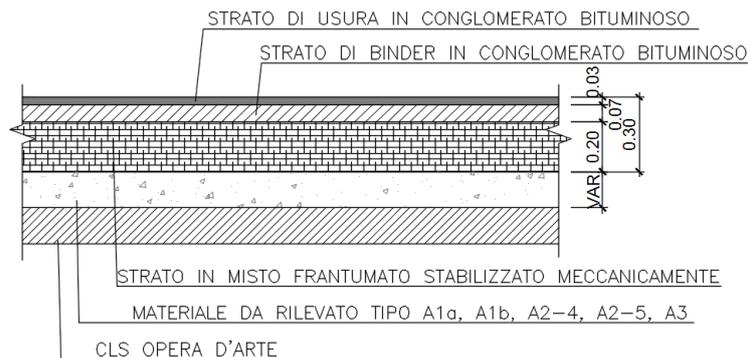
Sezione tipo in rilevato Strada Locale da 6 m
